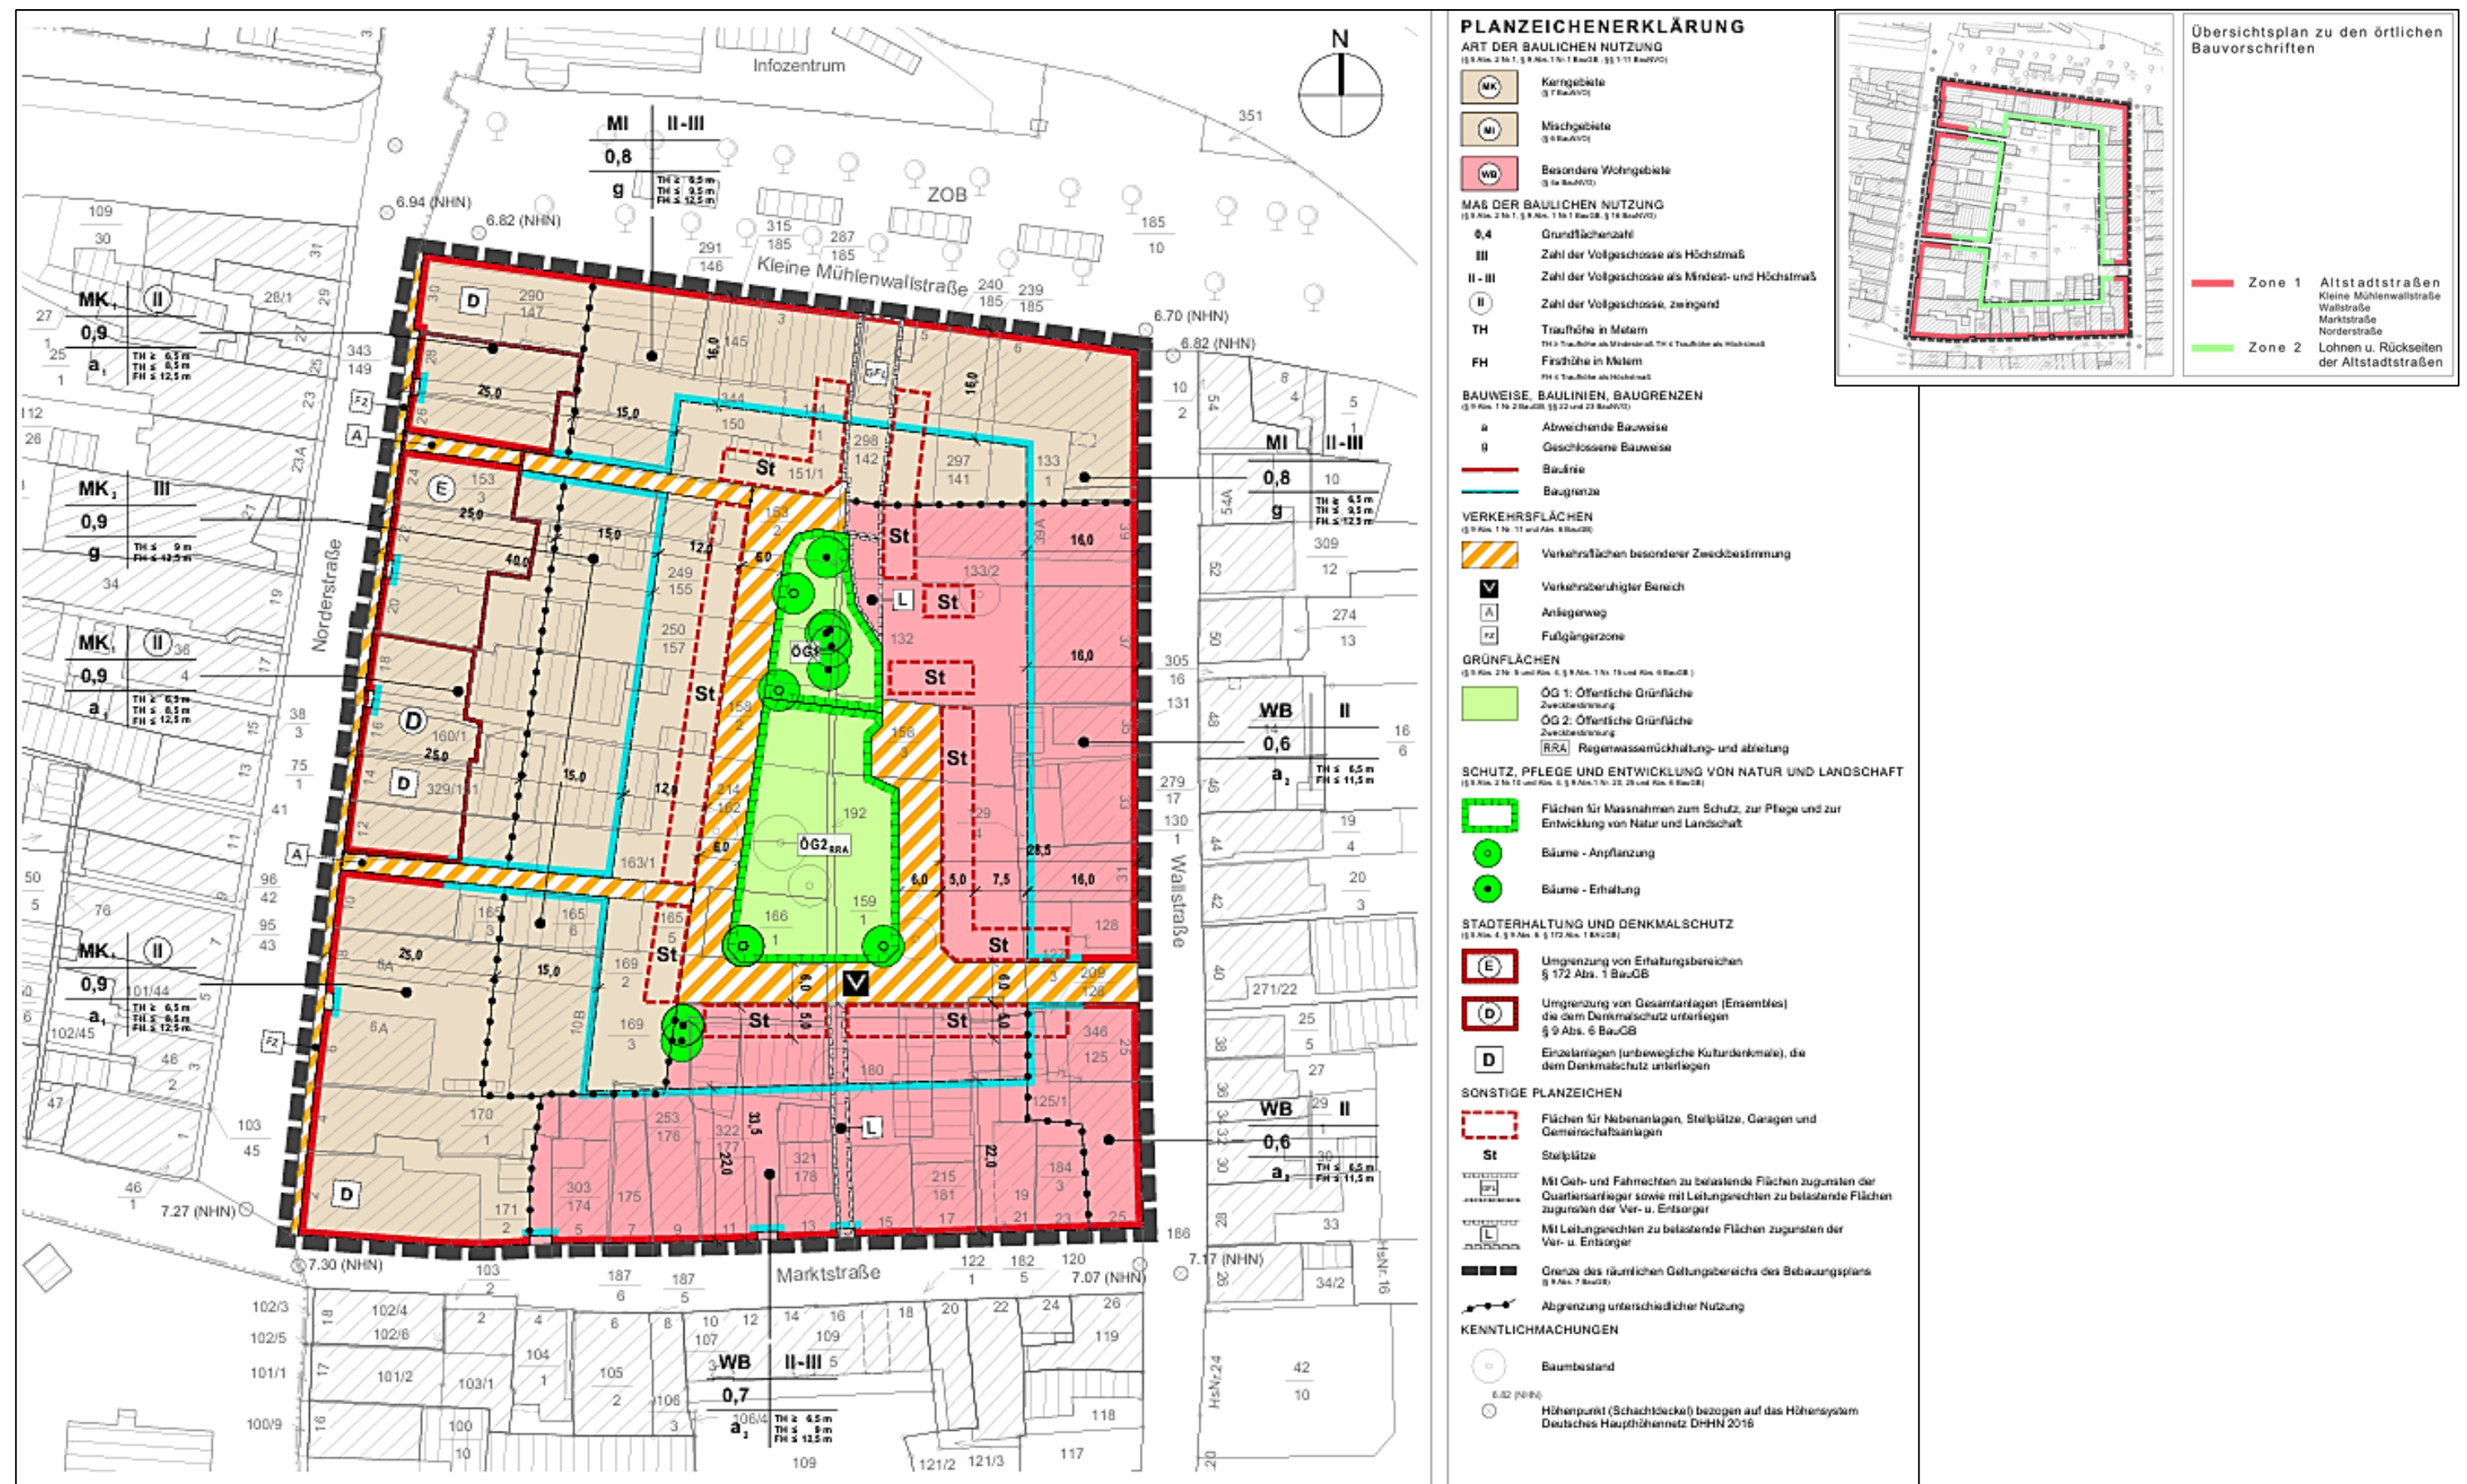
1. Änderung des Bebauungsplan s Nr. 173 (Dipl.-Ing. Architekt J. Schmidt). Rechts oben: Der Bereich wird in zwei Zonen aufgeteilt, in Zone 1 der Altstadtstraßen und einen inneren Bereich der Löhnen und Rückseiten der Altstadtstraßen.
